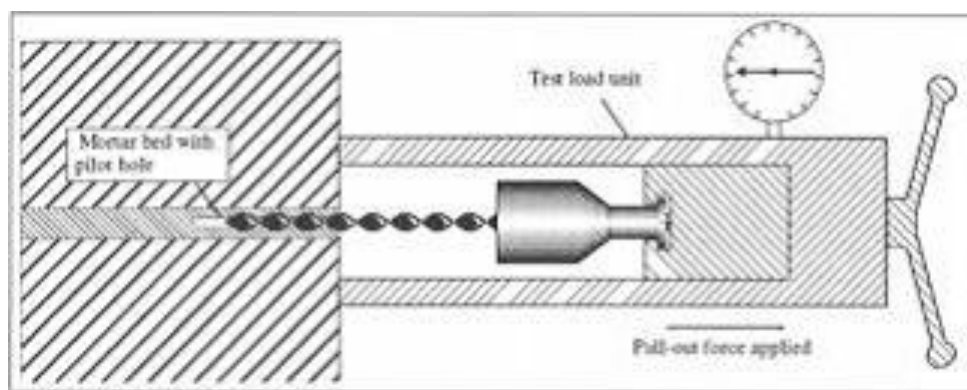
Schema di esecuzione della prova di pull-out (RILEM, 1996).
